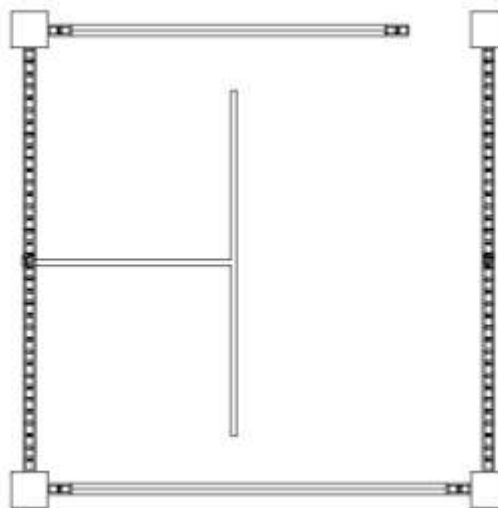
MUROS EXTERIORES DEL EDIFICIO
